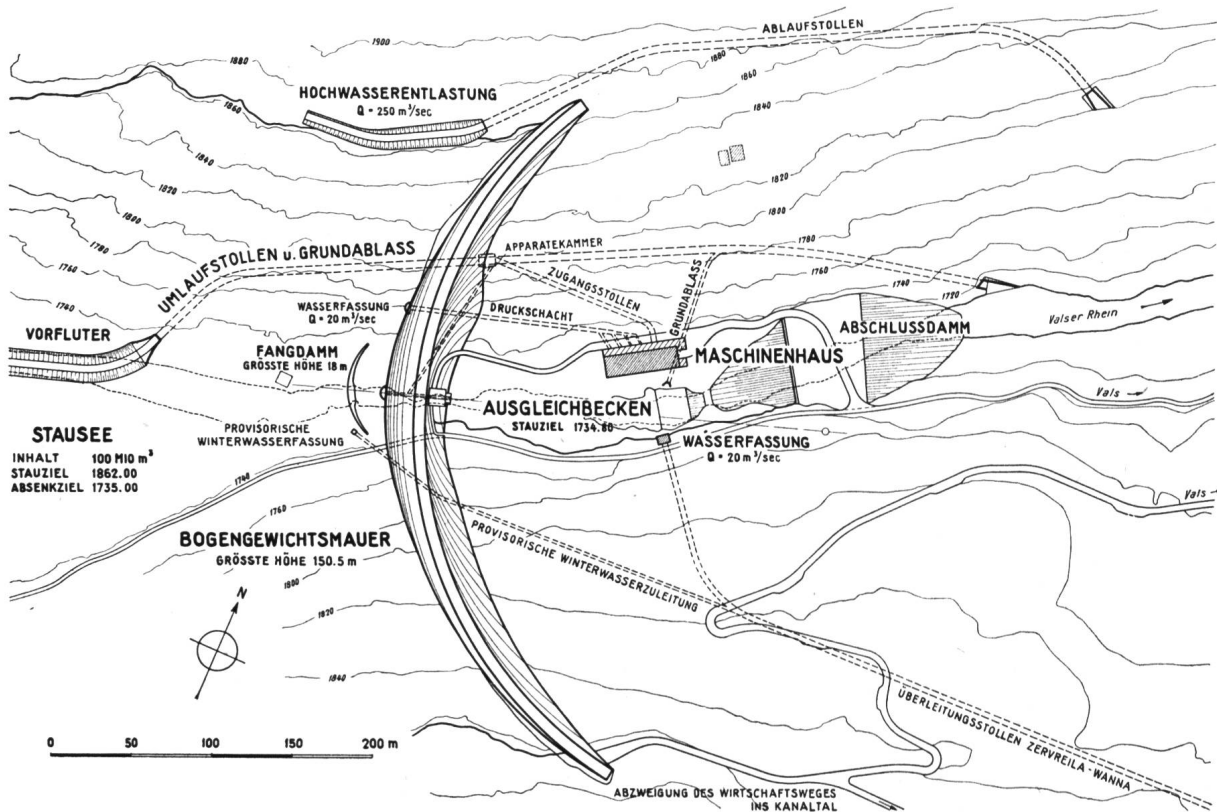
Seekraftwerk Zervreila, Lageplan mit Staumauer, Maschinenhaus und Ausgleichsbecken, 1:5000.
